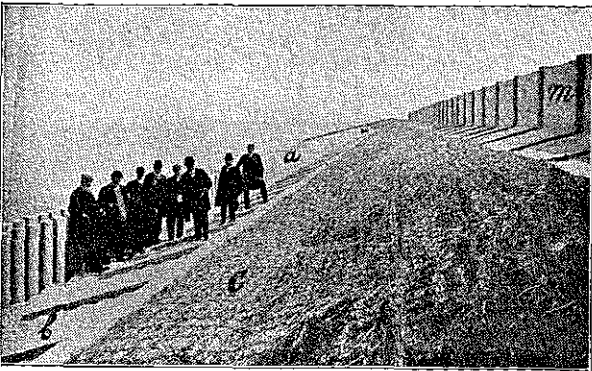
De z.g. Gewapendbetoncommissie van de Zuiderzeevereniging bezoekt het betonwerk aan den Langendijk van Schouwen
